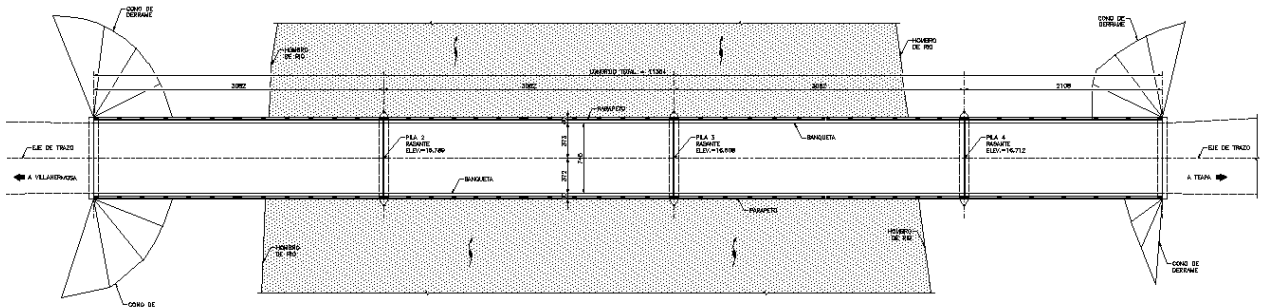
Vista en planta del puente Majahua I con el río Pichucalco. Ver en Anexo 01
